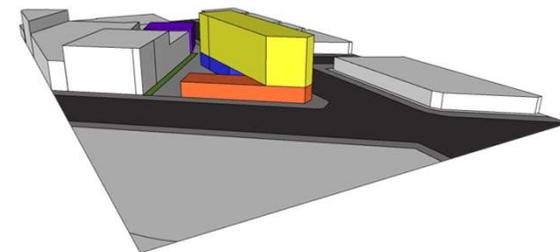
Opção 01 vista da Av. João Pessoa |
